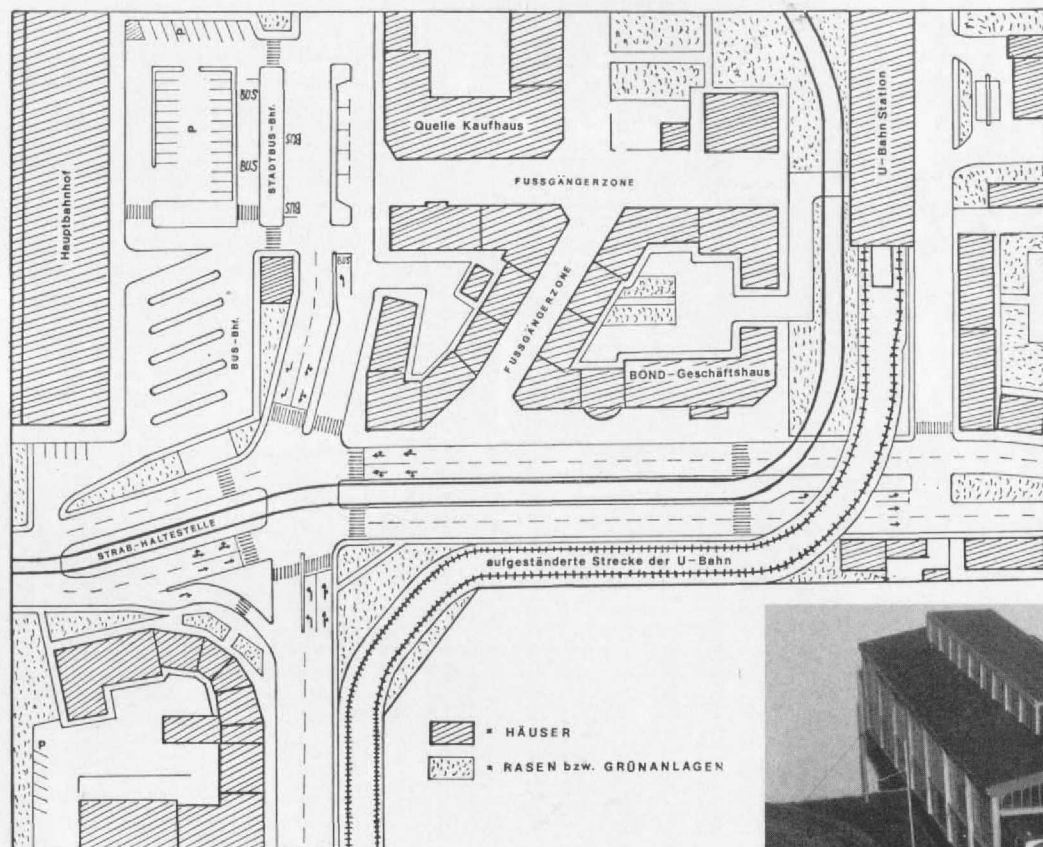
Plan des bis jetzt fertiggestellten Anlagenteilstücks im Maßstab 1:18 mit U-Bahn- und Straßenbahnstrecke.
